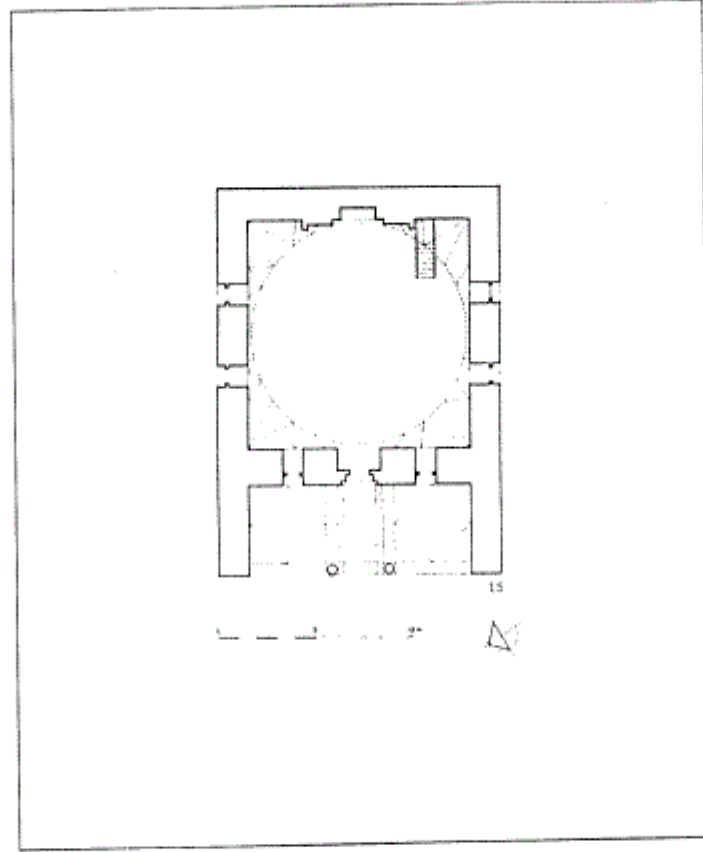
مسقط أفقي لمسجد أحمد باشا هرسك أوغلو في قيشان (عن : اصلان ابا) .
